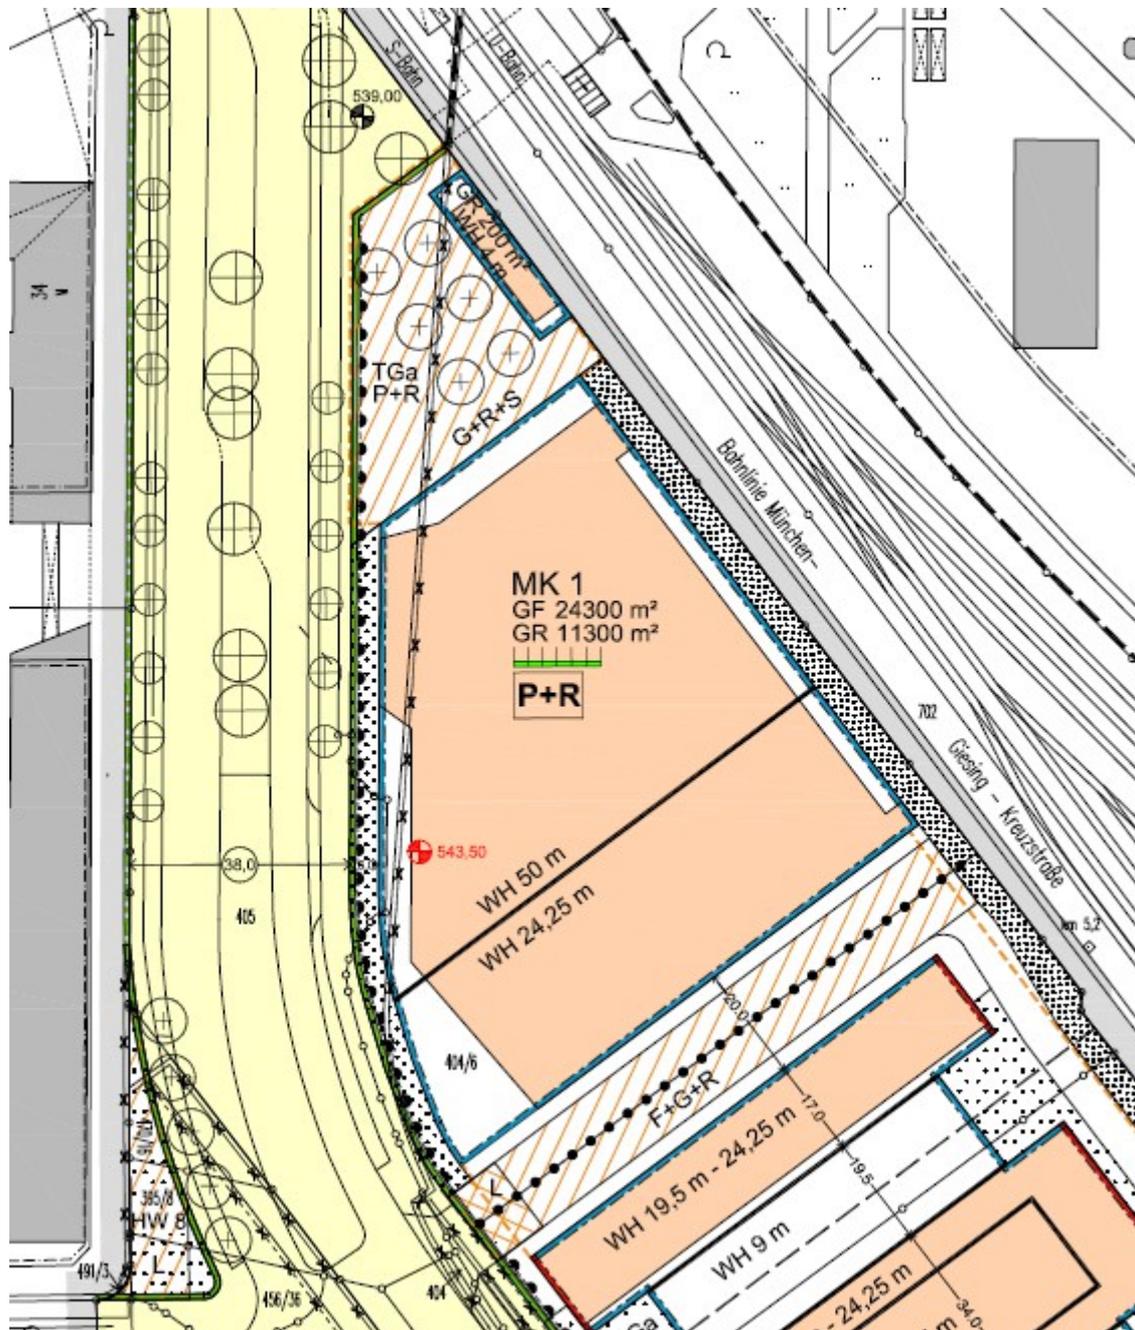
Lageplan der P+R-Anlage; © Stadtwerke München GmbH
